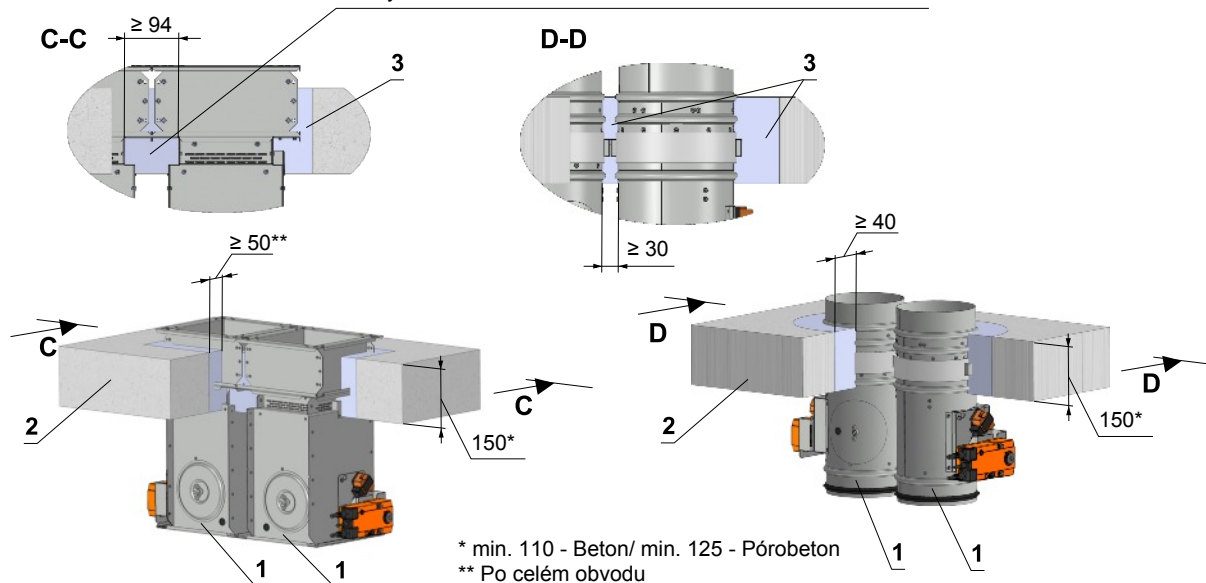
Tuhá stropní konstrukce - baterie - sádra nebo malta
